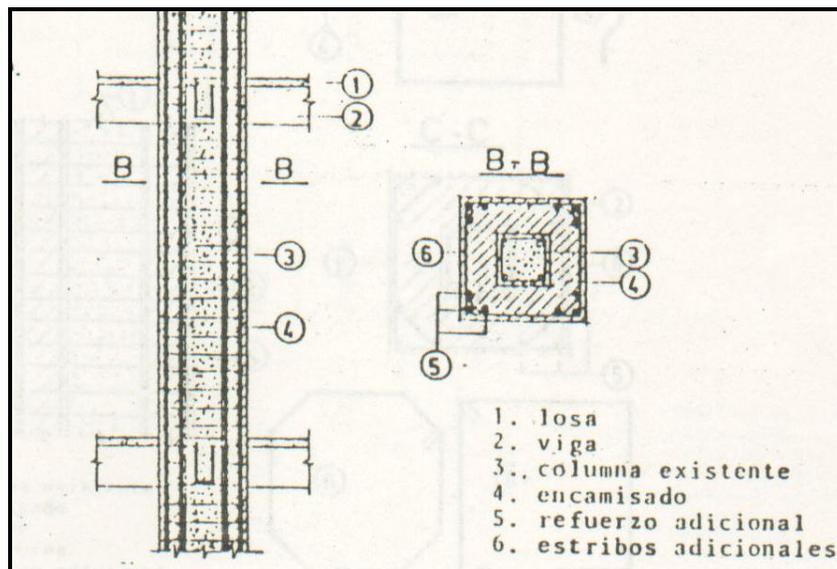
Encamisado de columnas con concreto reforzado¹⁷.
